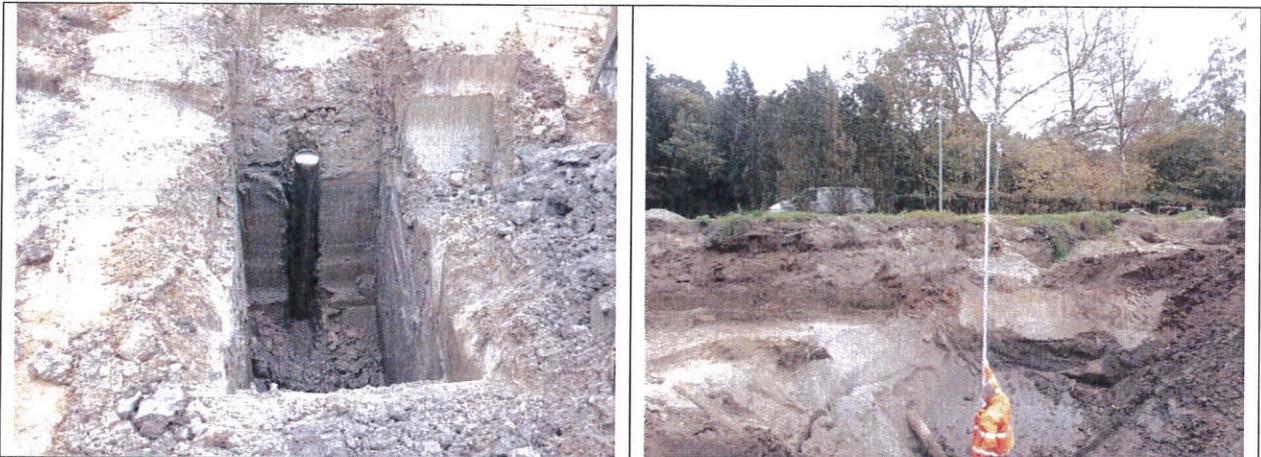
Bilder des im Baugrund vorgefundenen Brunnens
